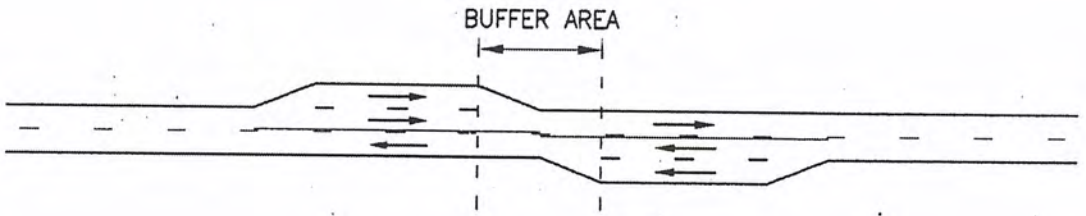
รูปแบบ E : ADJOINING (TAIL TO TAIL) (RECOMMENDED)
